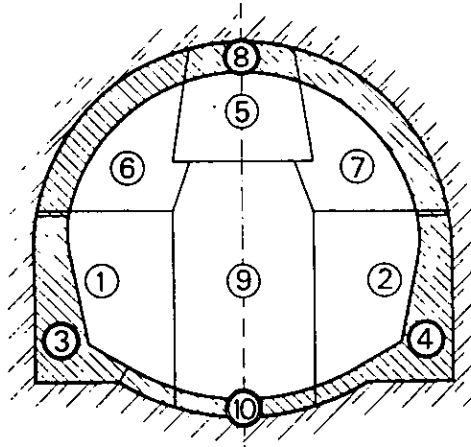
PROCEDIMIENTO DE EXCAVACION
